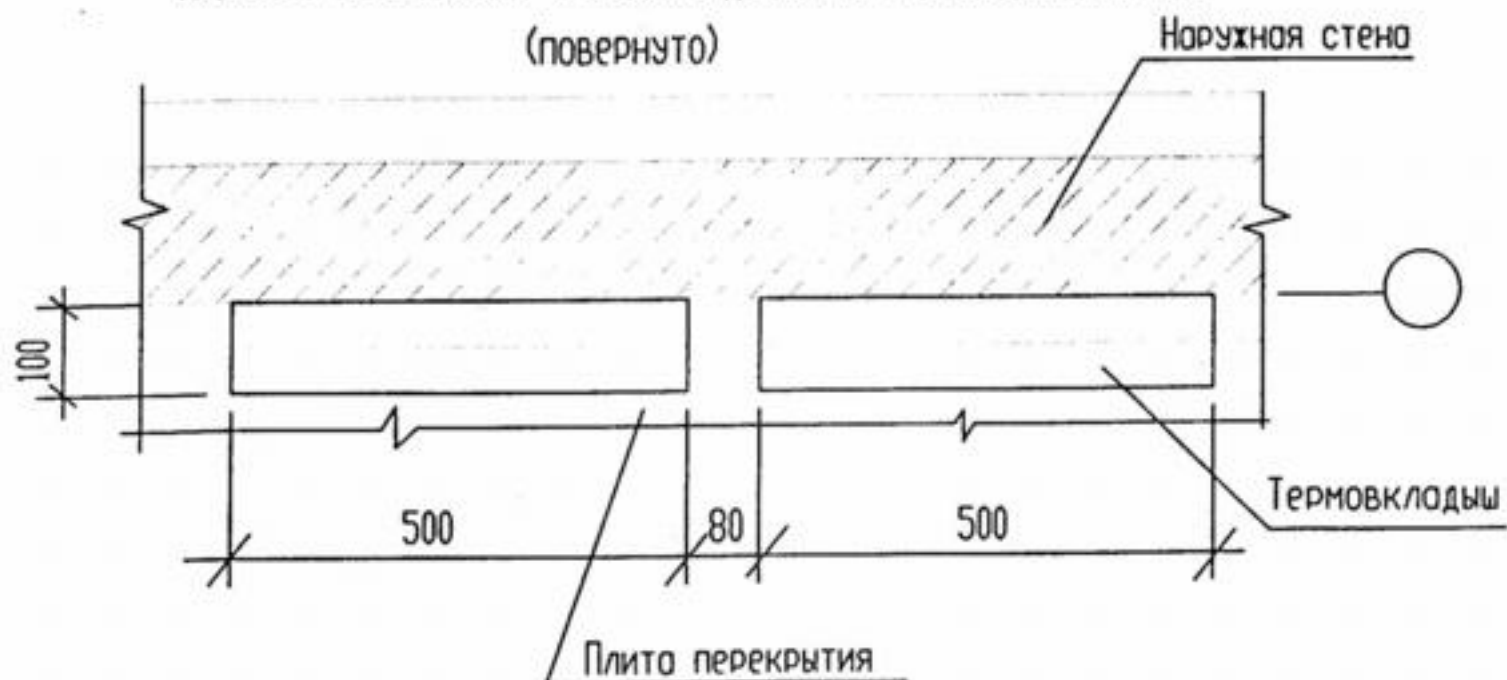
Поэтажные противопожарные рассечки. Фрагмент стены
